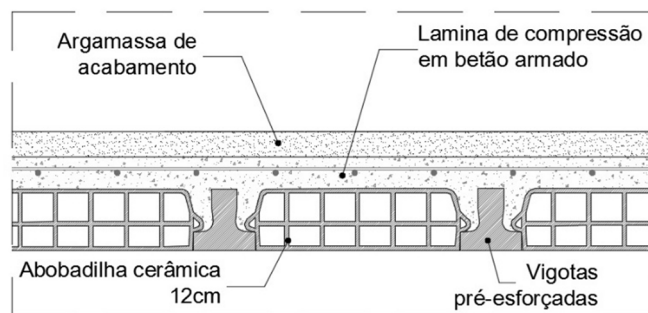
Pormenor de pavimento em betão (s/escala) – (Autor)
